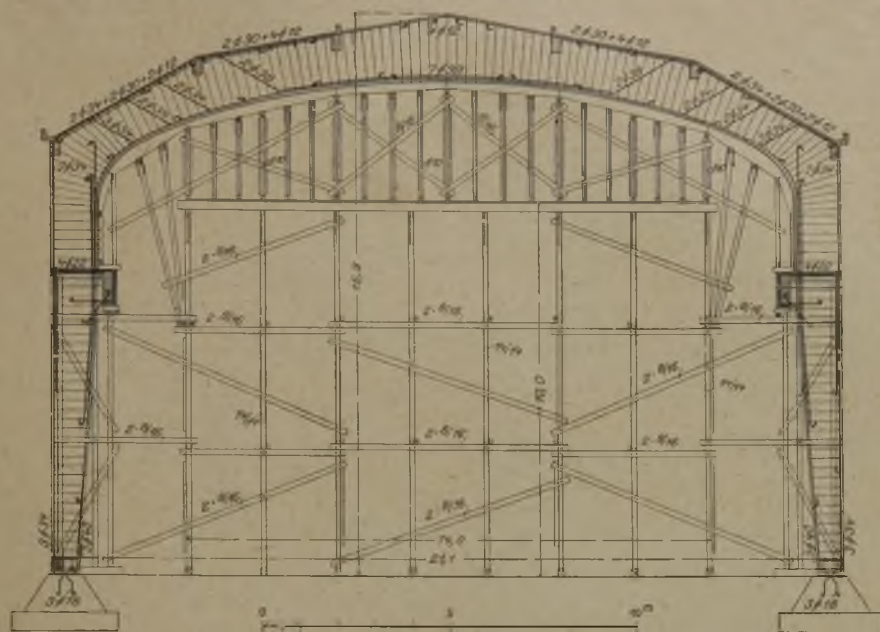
Bewehrung eines Hallenbinders mit Einzeichnung des Lehrgerüsts.
